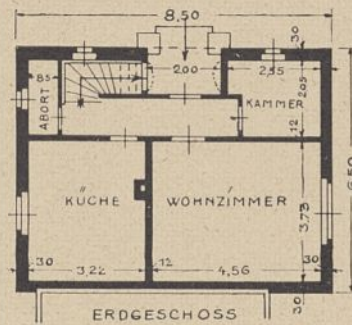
u. 59. Grundrisse zu Abb. 57.
